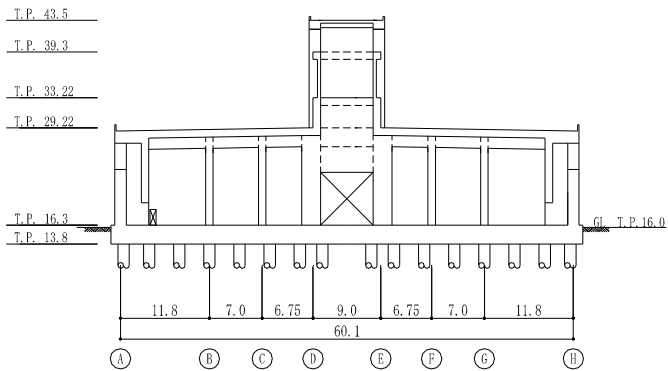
8 B - B 断面図 (EW 方向) (単位 : m)
